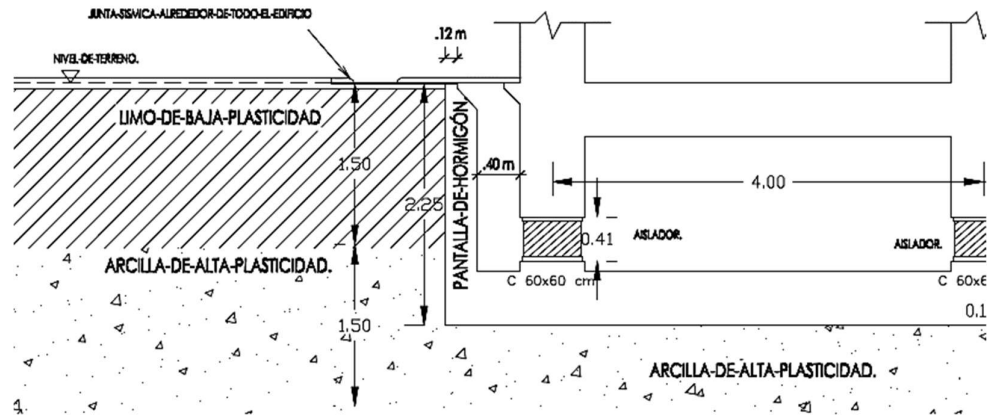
Corte transversal de losa de cimentación 22.00mx22.00m.
